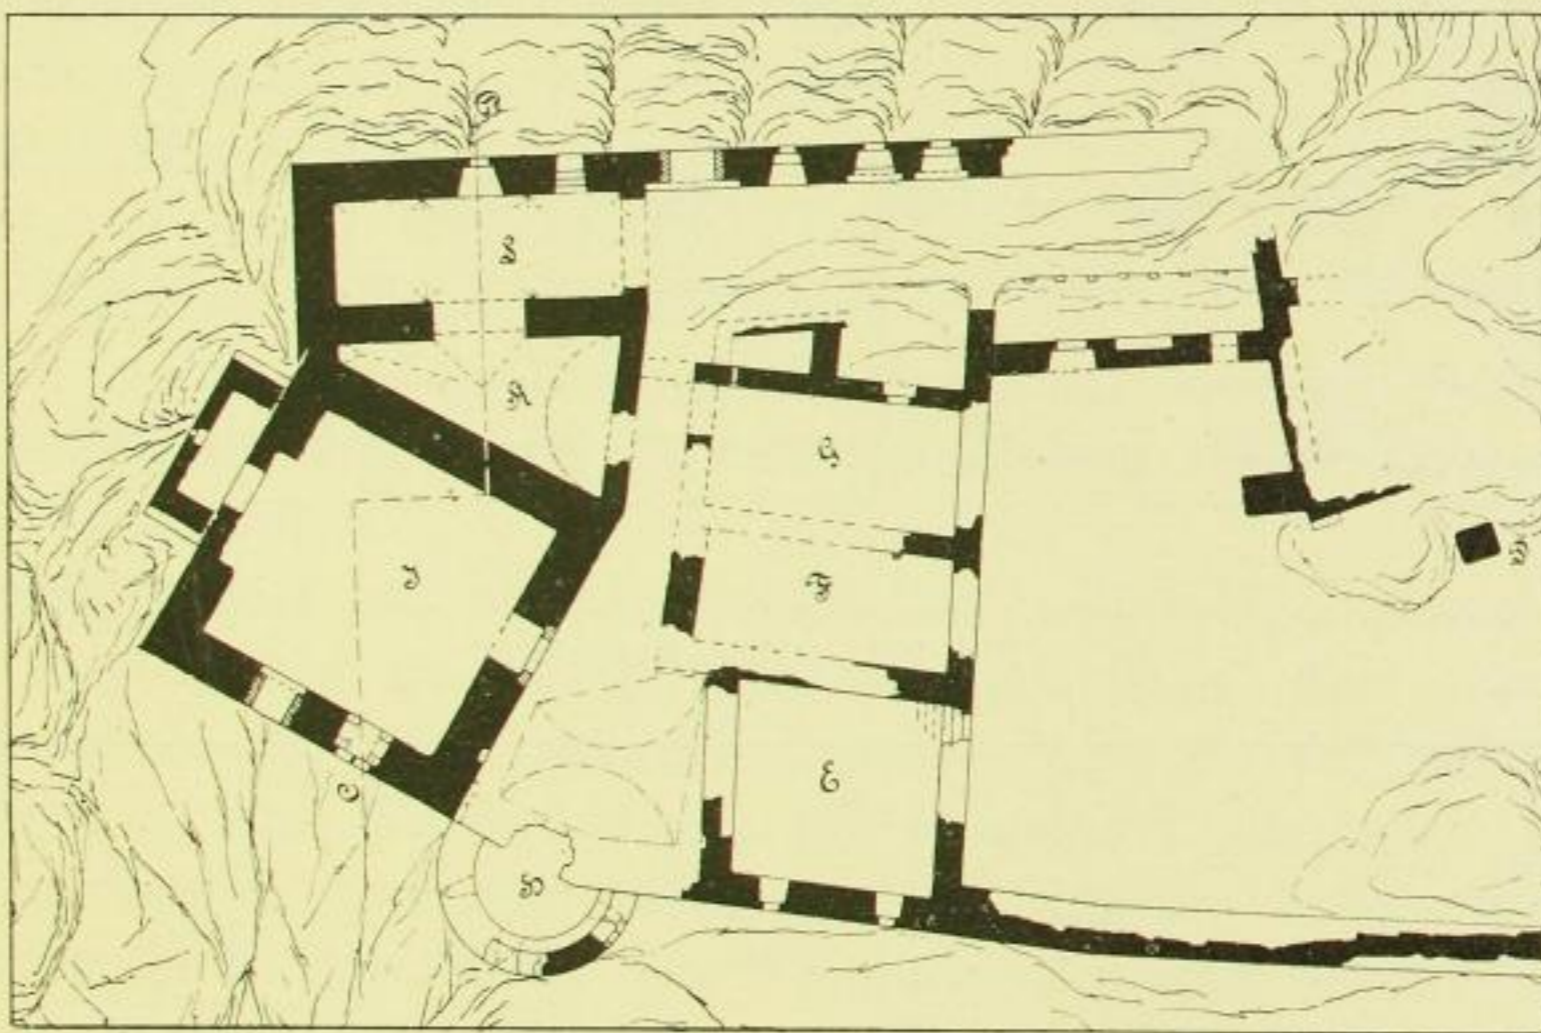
Oybin, Westbau, Grundriß des Untergeschosses.
